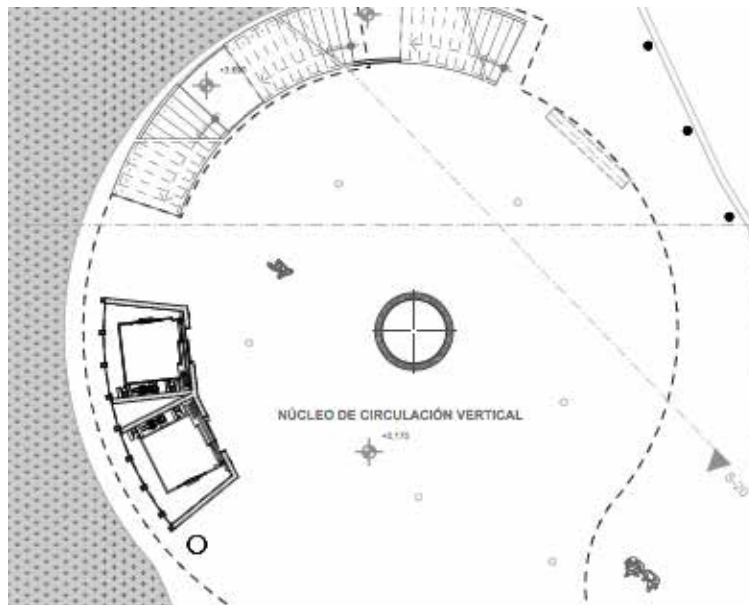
Plaza de acceso 4, planta baja. (+0.17m). (2017)
